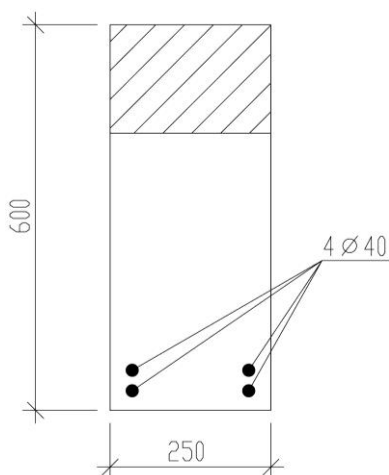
Армирование ригеля в растянутой зоне 1–го пролета
